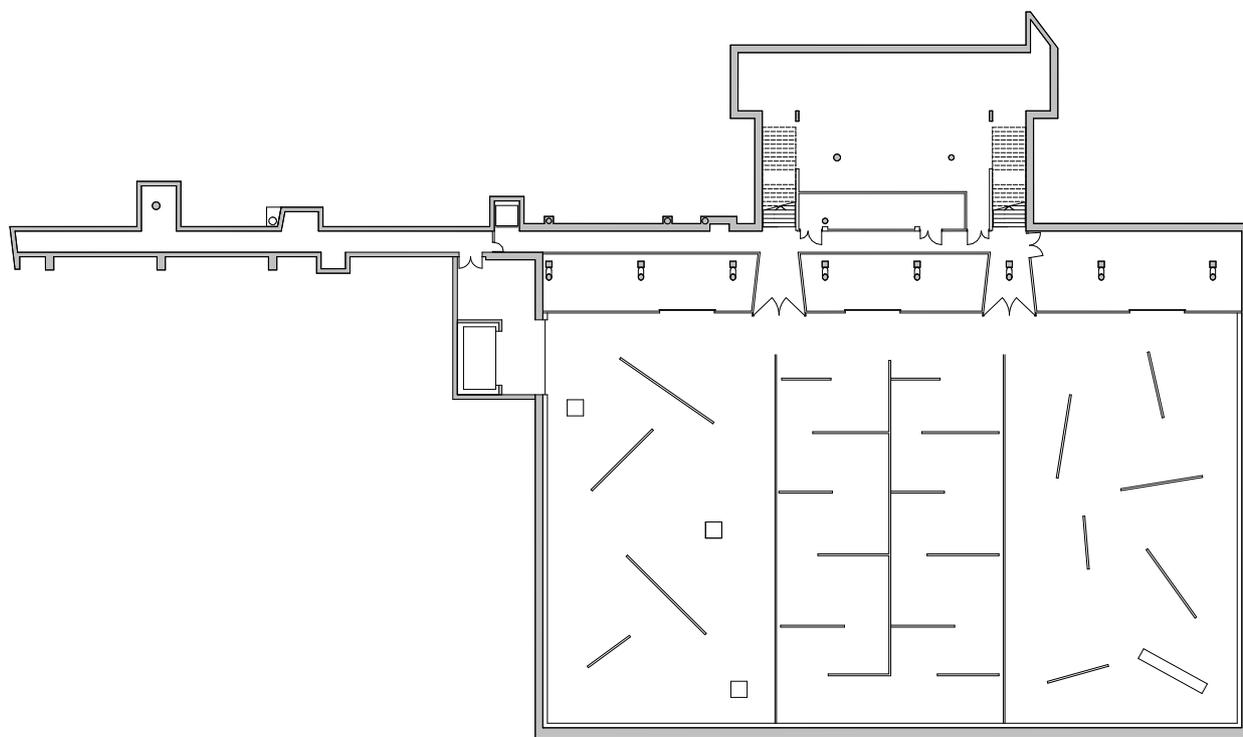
Grundriss 2.UG - Ausstellungen
